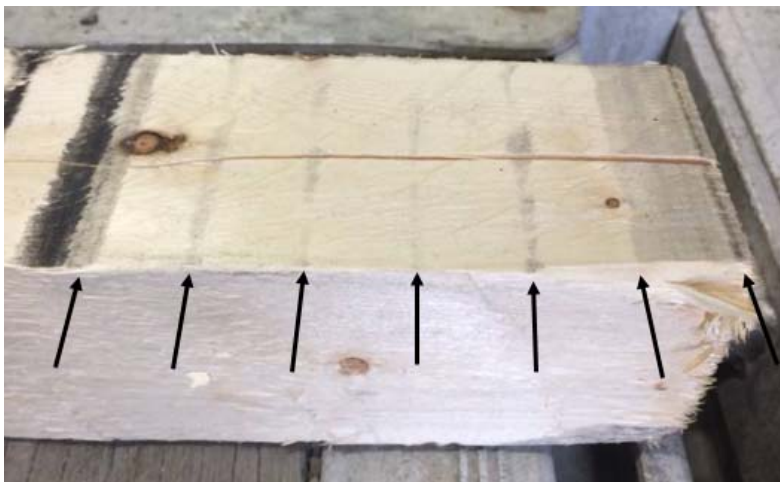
Marques laissées par le dépôt temporaire du paquet sur la cale avant
